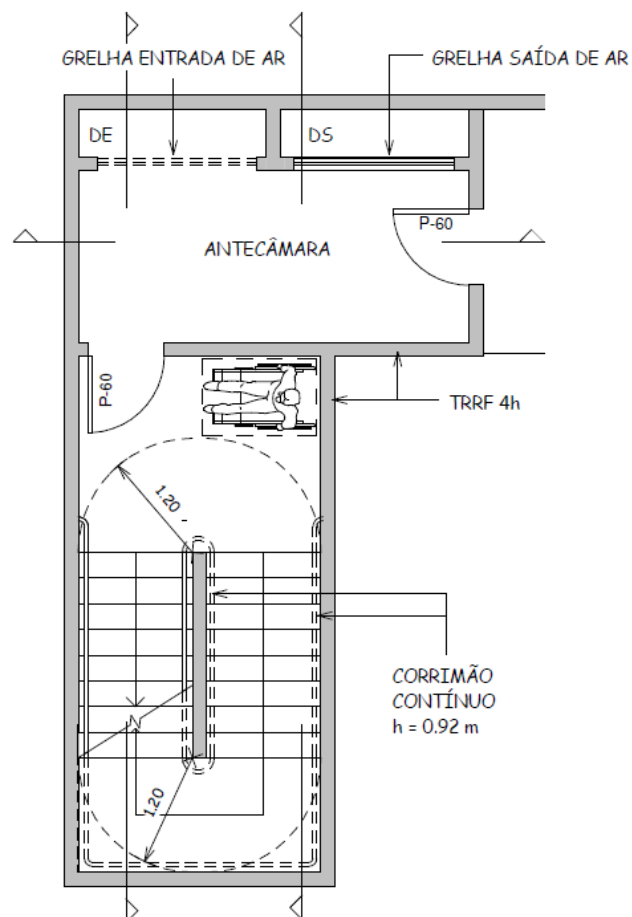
B - Escada à prova de fumaça - pavimento intermediário (planta baixa).
